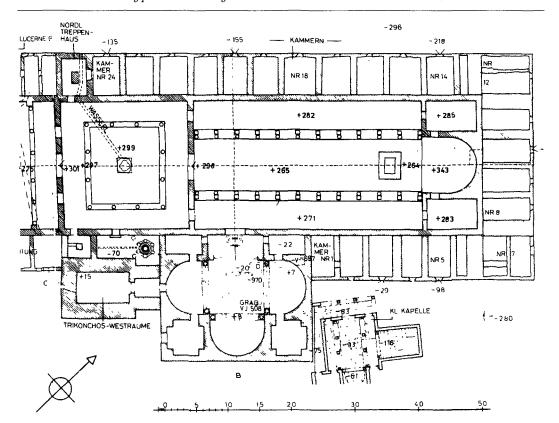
Tebessa, Basilika u. Trikonchos, Grundriss mit Angabe des Schnittes Abb. 10. Nach Christern, Pilgerheiligtum Fig. 1.
